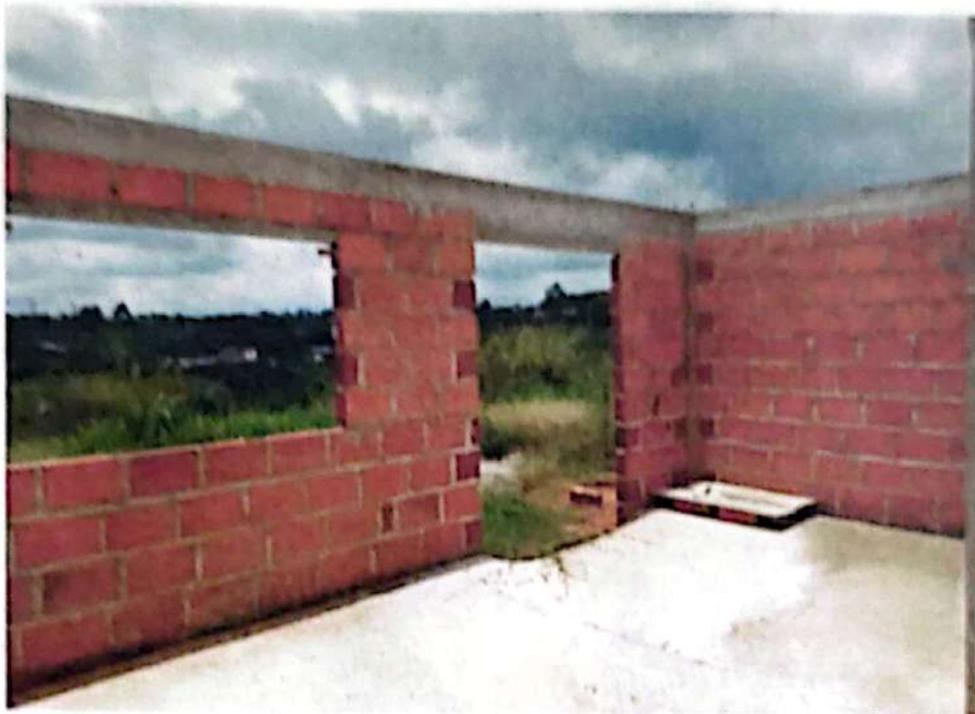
Vista interior de la Sala hacia el hall de los baños y alcobas. Muros terminados en mampostería de ladrillo a la altura de Vigas de amarre.
